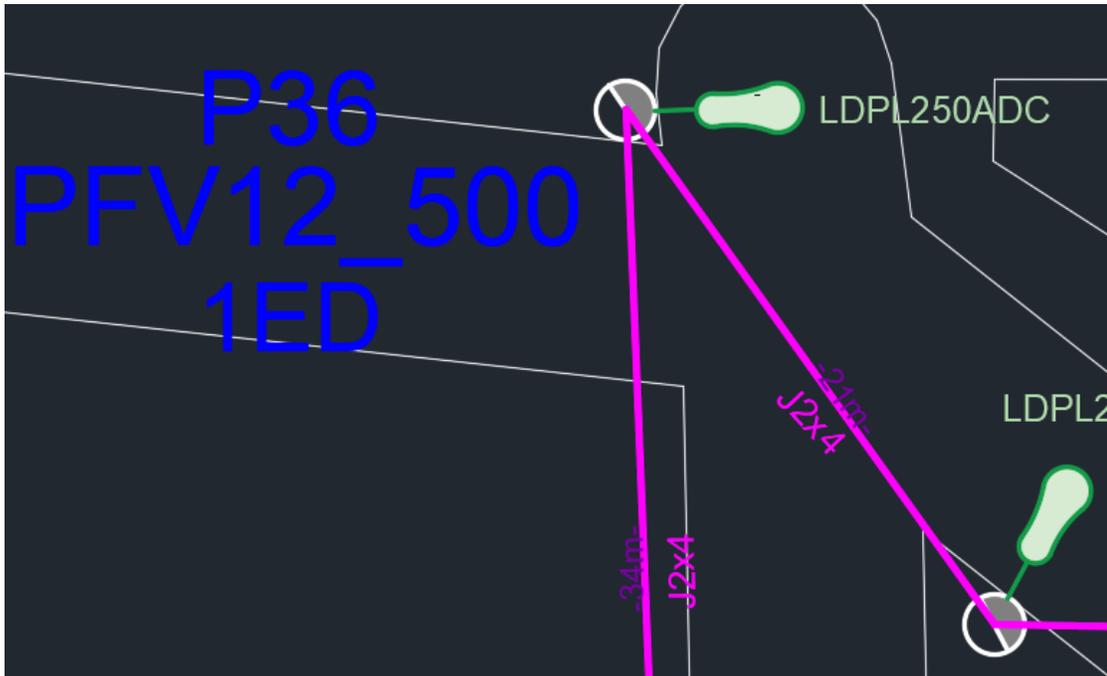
Plano de la propuesta diseñado en AutoCAD (Zoom).
